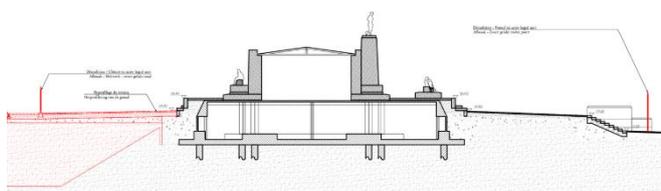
sit. existante – coupe extr. du dossier de demande
